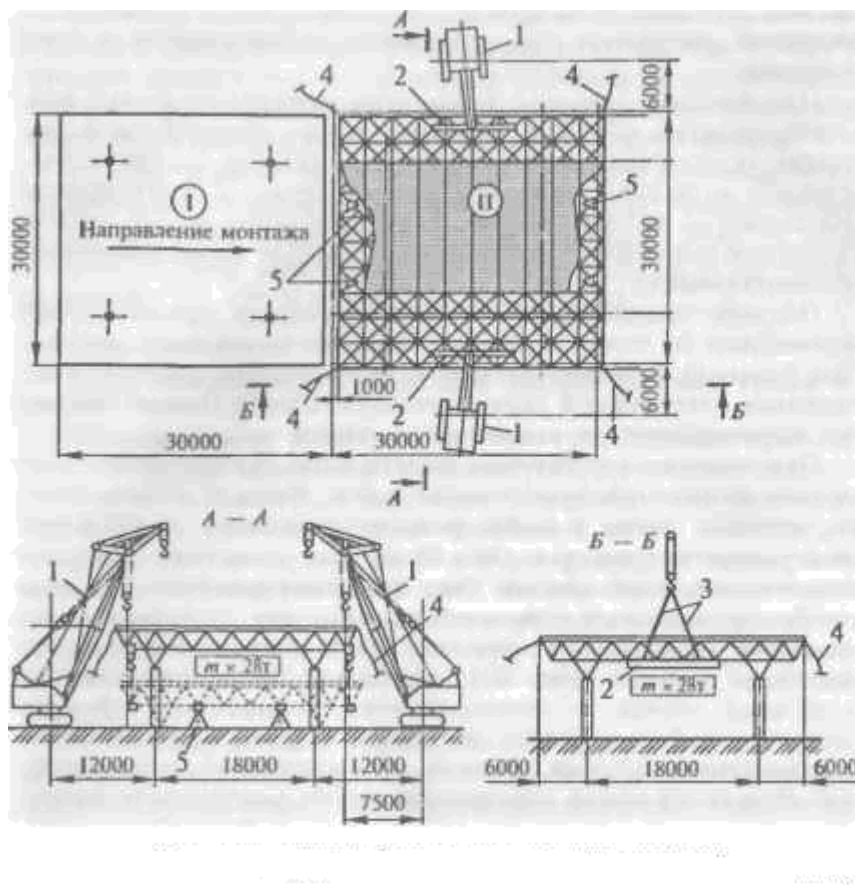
Монтаж блока покрытия двумя кранами:
